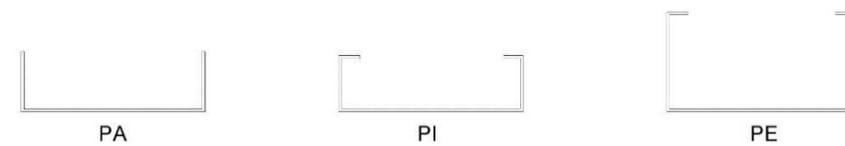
Planta de perfiles galvanizados plycem. Fuente: Plycem
